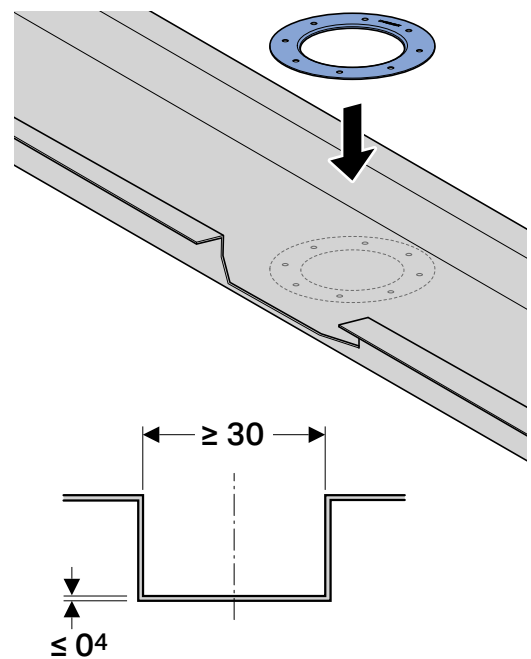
Maße bei Montage mit Befestigungsflansch
